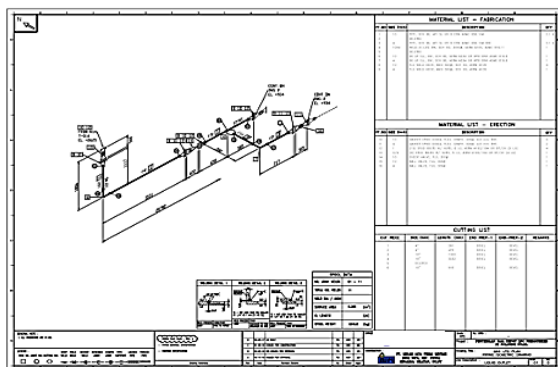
Mini LPG Plan Piping Isometric Drawing 8
